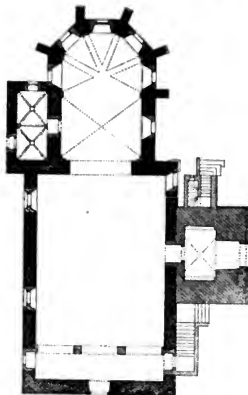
Lomnic. Grundriss der Pfarrkirche.
